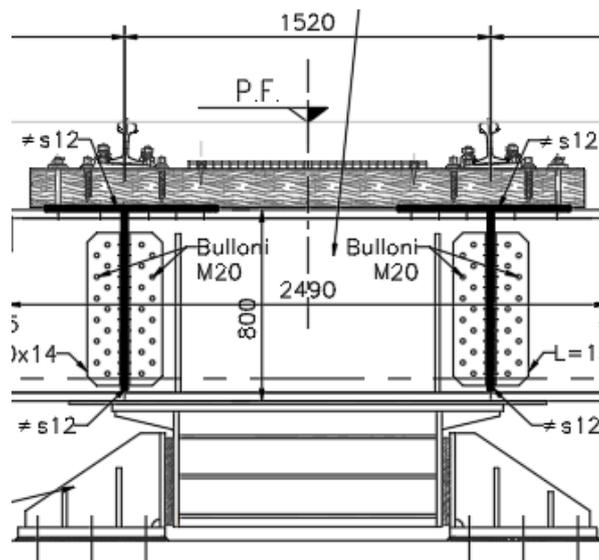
Sezione longitudinale dispositivi di appoggio fisso
